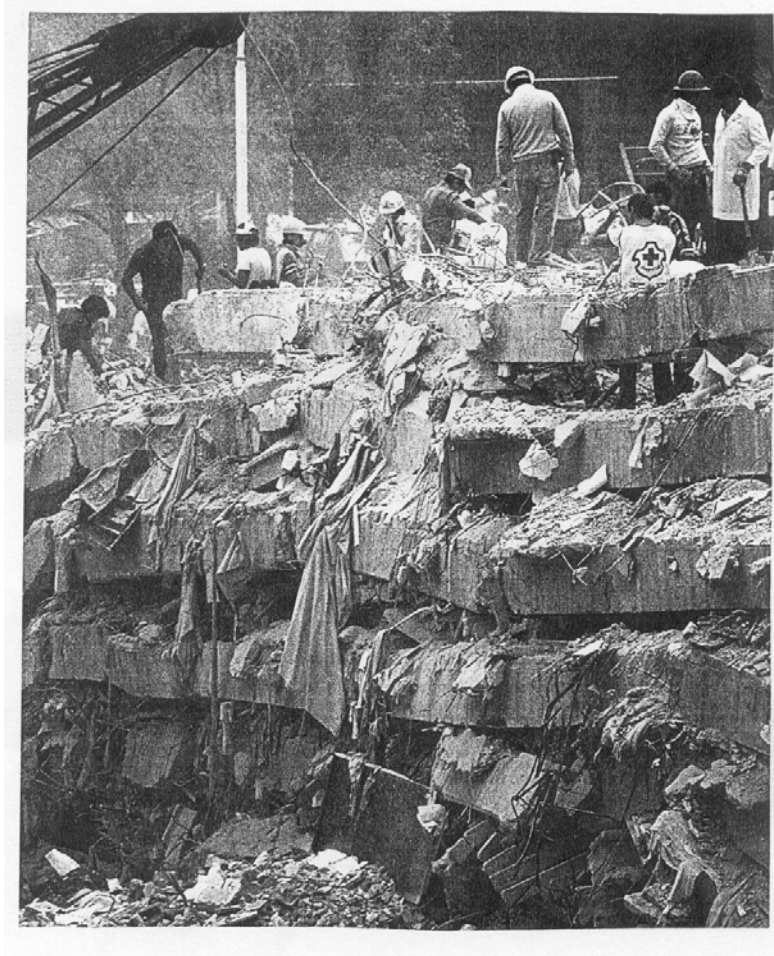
Effet de la ruine de poteaux faibles : l'empilement des planchers après séisme.
